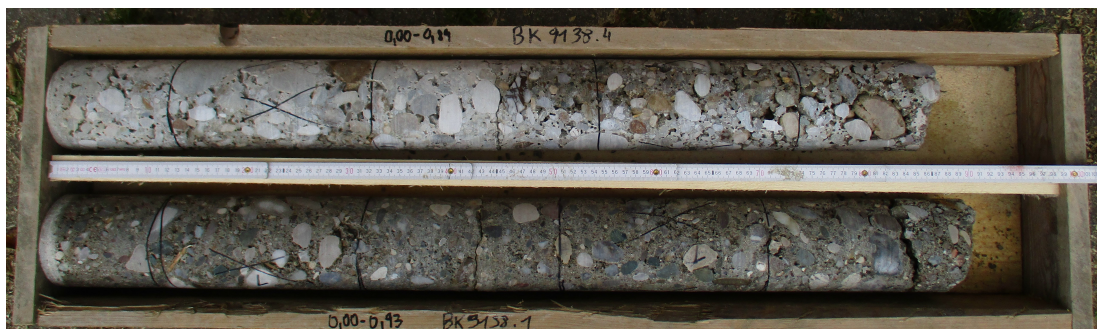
Bohrkiste mit beschrifteten Bohrkernen einer Rotationskernbohrung [24]
